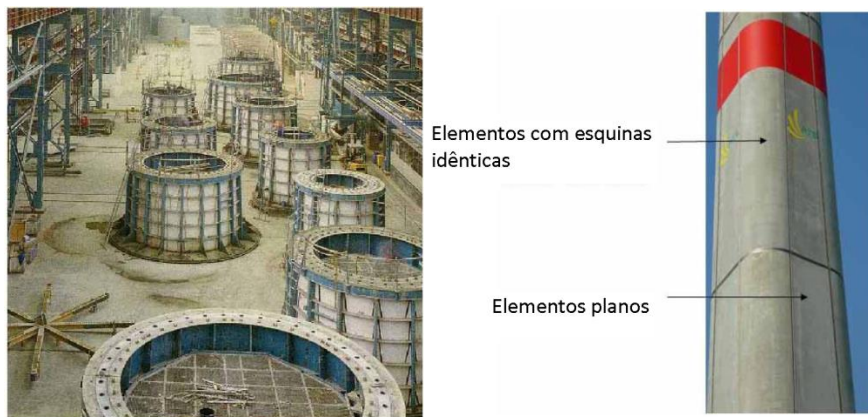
a) Cofragem da empresa Enercon, para a construção de torres cónicas. b) Torre da empresa, Advanced Tower Systems, constituída por elementos pré-fabricados. Fonte: [49]
